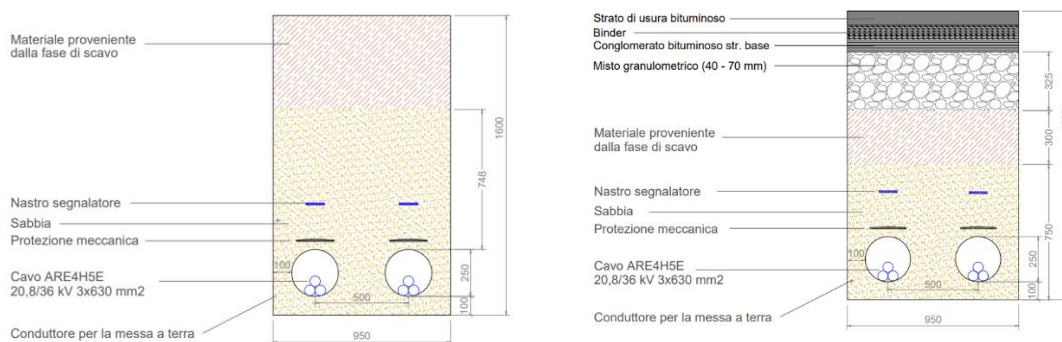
Sezione di scavo per cavidotto AT interrato (Rete ad anello – PB - CC)
